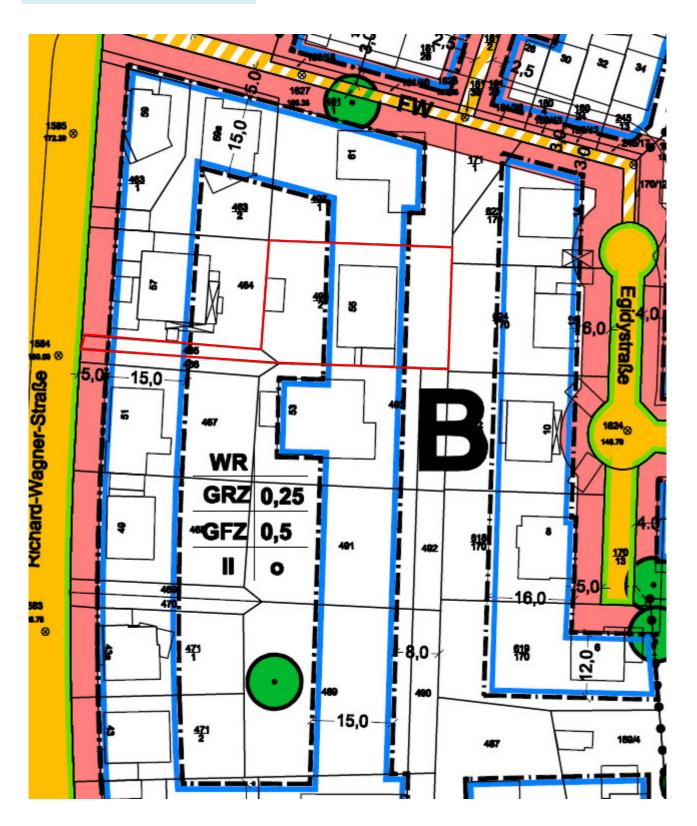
Auszug aus dem Bebauungsplan "Komponistenviertel" (nördlicher Teil), Planteil (o. Maßstab); Quelle: Bauleitplanungsportal Stadt Wiesbaden; Roteintragung d.d. SV
